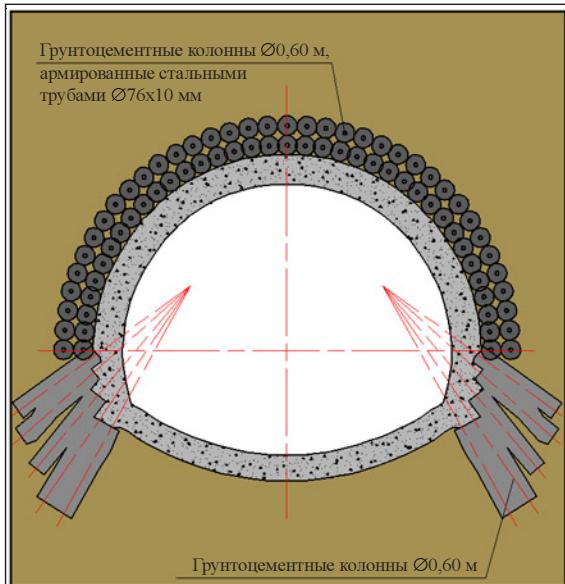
Струйная цементация грунтов на строительстве автодорожного тоннеля «Malenchini» на автостраде Livorno-Civitavecchia. Поперечное сечение в зоне нахлеста грунтоцементных колонн зонтика опережающей крепи.
